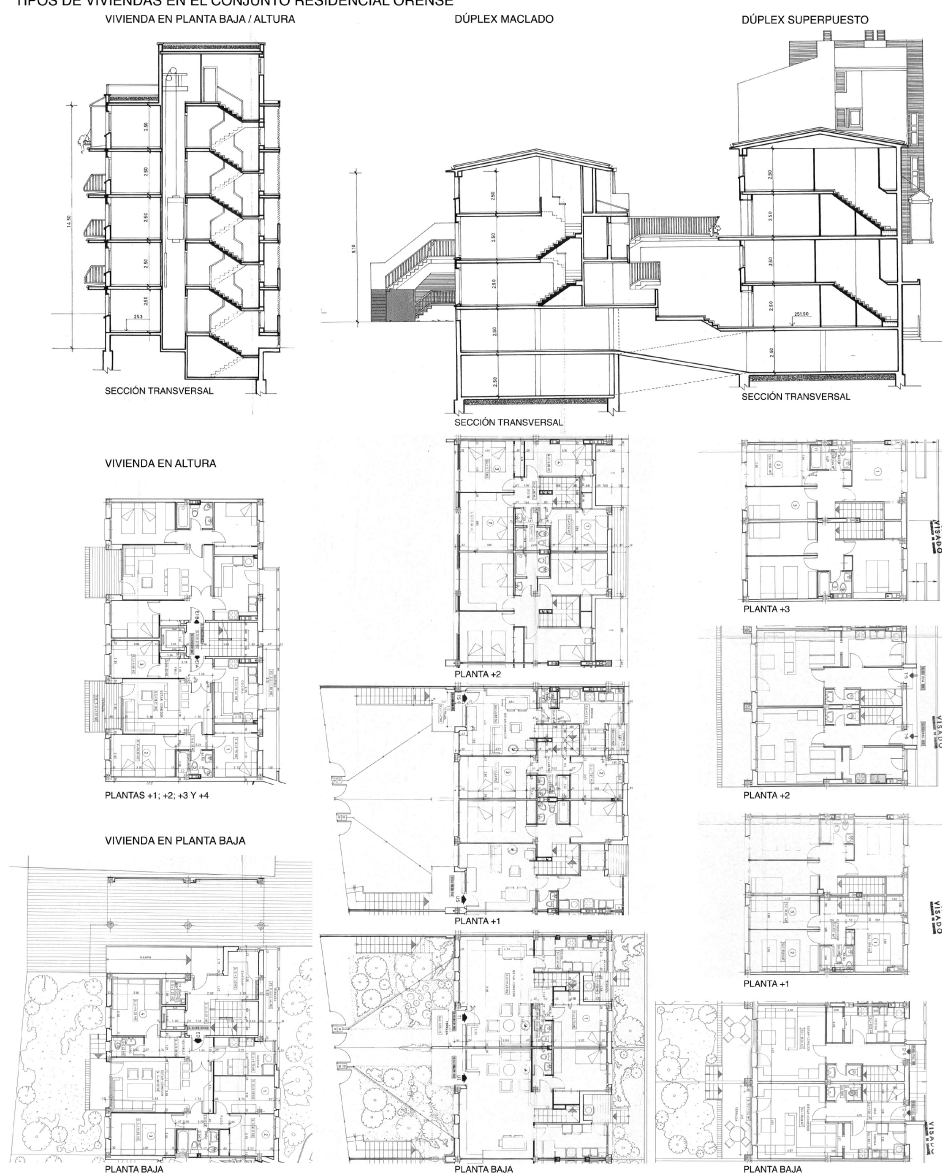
Distribución tipológica de viviendas del conjunto residencial Orense. Columna izquierda: Sección y plantas de los tipos definidos como viviendas en altura y en planta baja. Columna central: Sección y plantas del tipo definido como dúplex maclado. Columna derecha: Sección y plantas del tipo definido como dúplex superpuesto.
